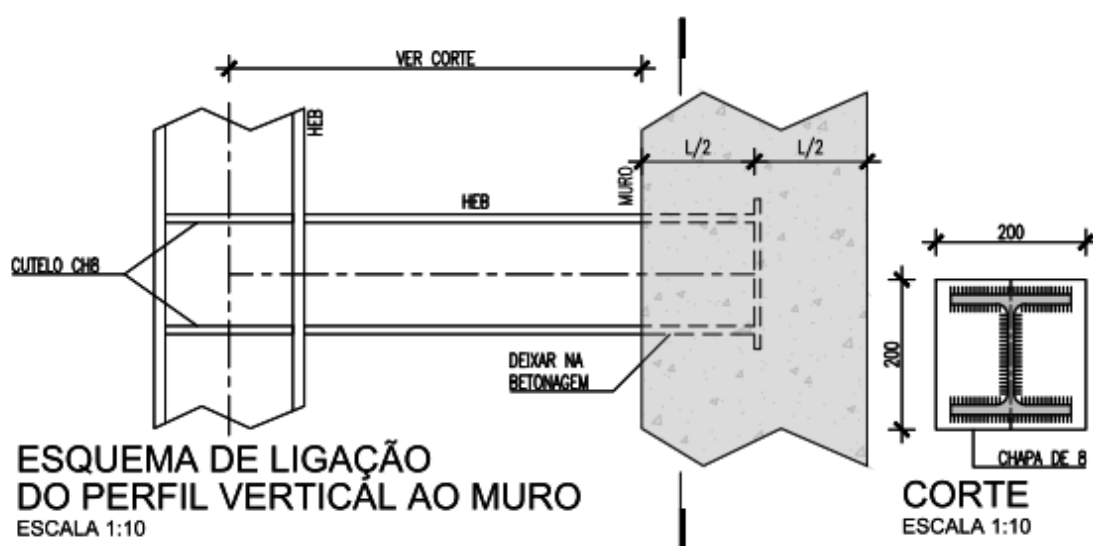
Esquema de Ligação perfil – muro. [Fonte: Projeto de Estruturas de Contenção Periférica]
